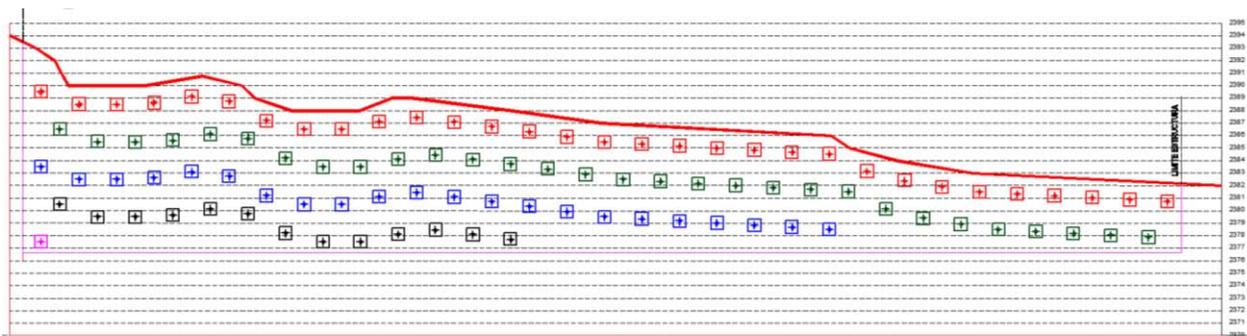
CORTE C-C', SISTEMA DE ANCLAJE
